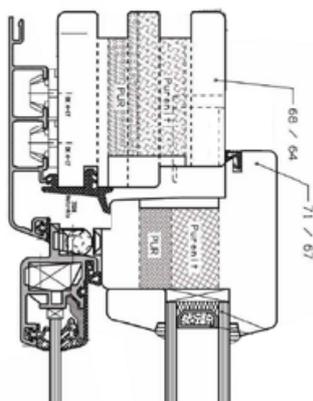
Schemaschnitt Fensterkonstruktion mit Einbausituation Massivbau
